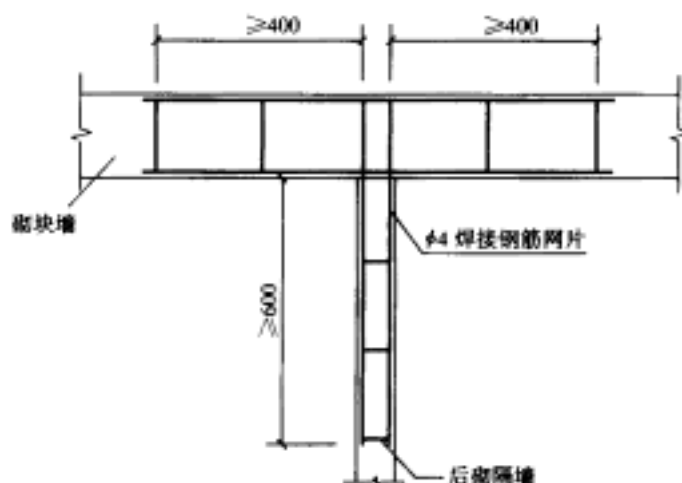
砌块墙与后砌隔墙交接处钢筋网片
